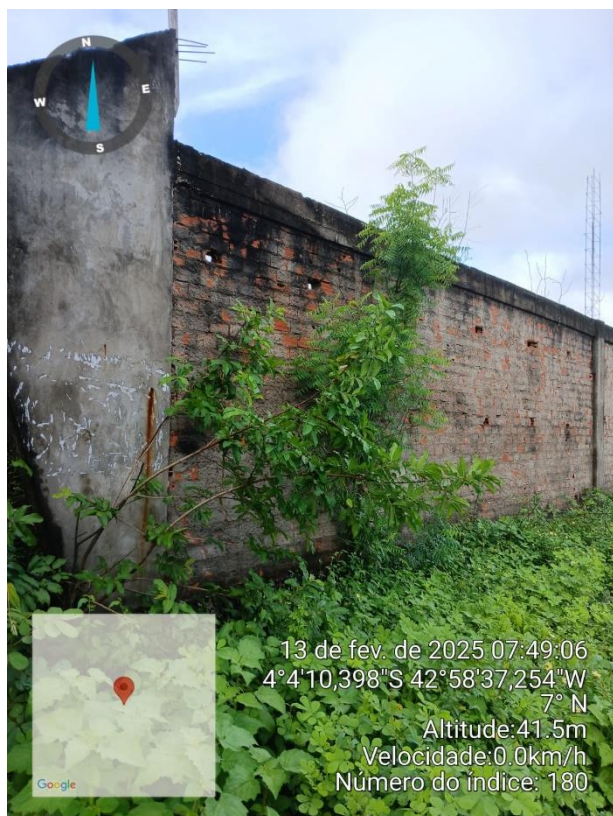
Vista da Estrutura, pilares e vigas, executadas parcialmente. Fonte: elaboração própria.
